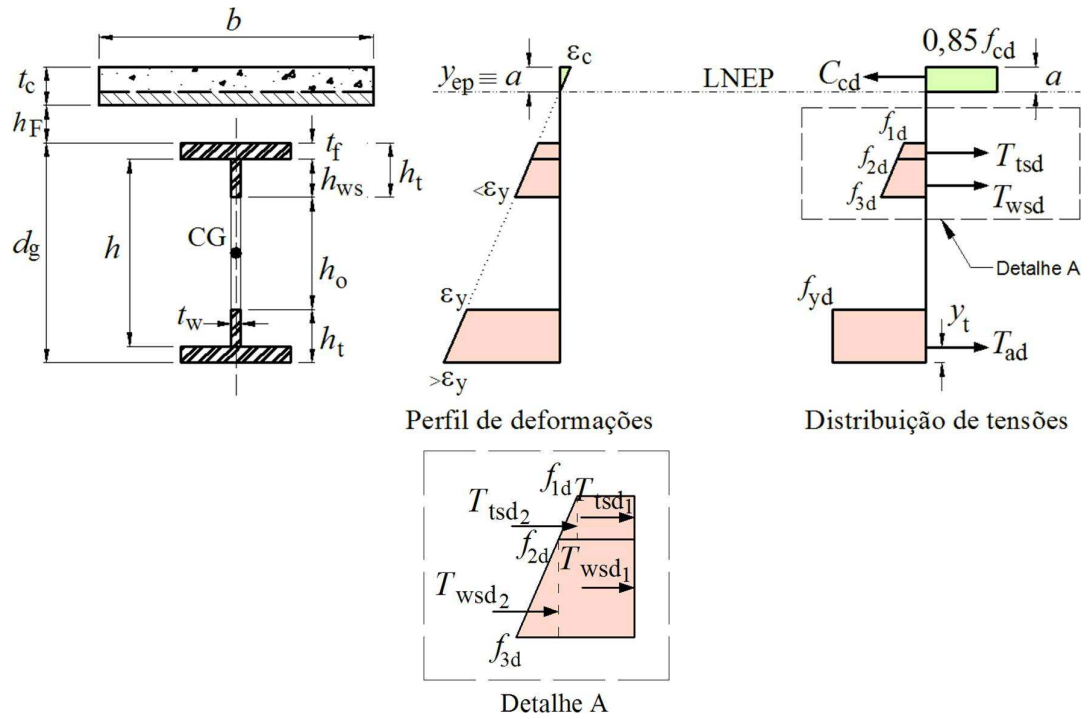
Perfil de deformações e distribuição de tensões em uma viga alveolar mista com a LNEP na laje (interação completa).
